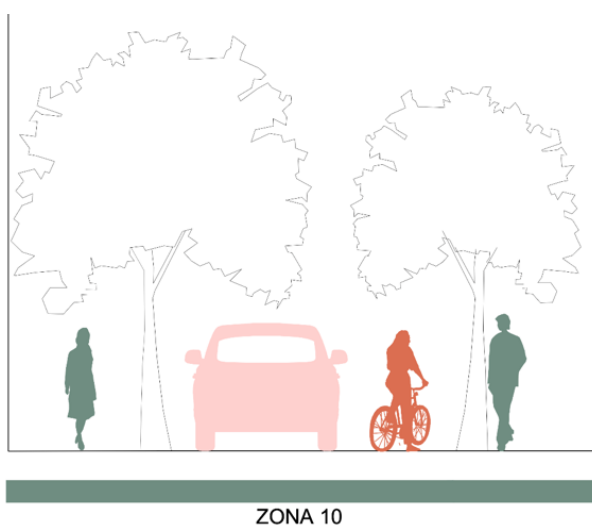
Possibile trasformazione della sezione stradale di via Piave – Opzione 3
